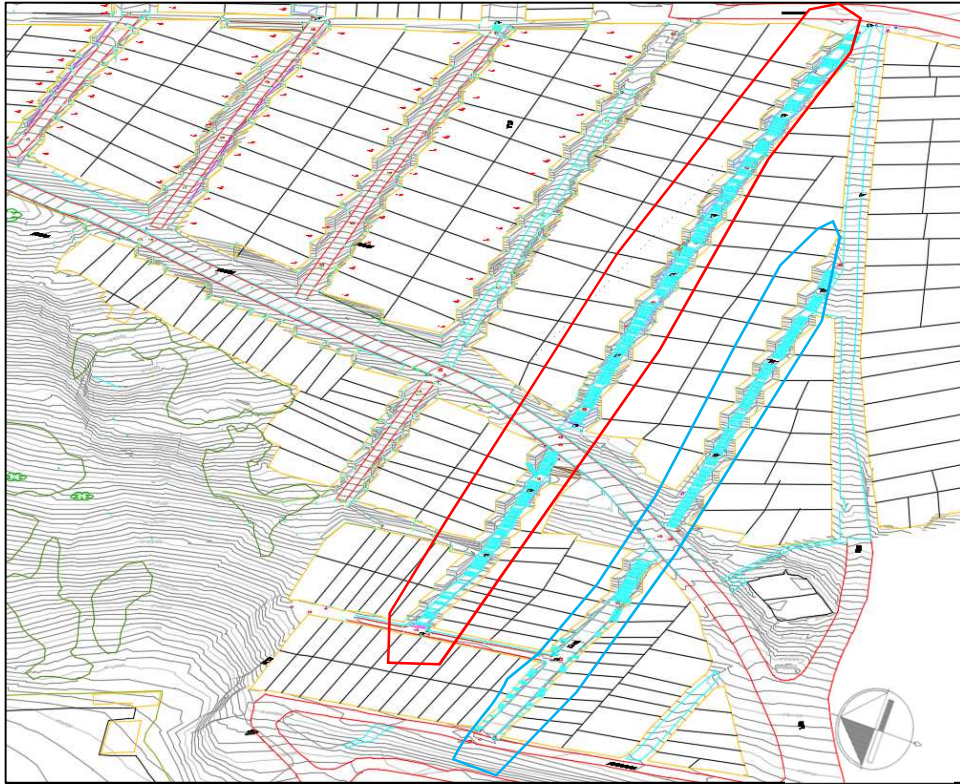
Zonas de levantamiento con detalle (zona1 color rojo y zona2 color azul)
